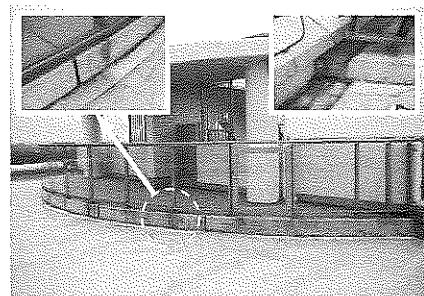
防水層上に大がかりなコンクリートのステージを打ち込んだ例
